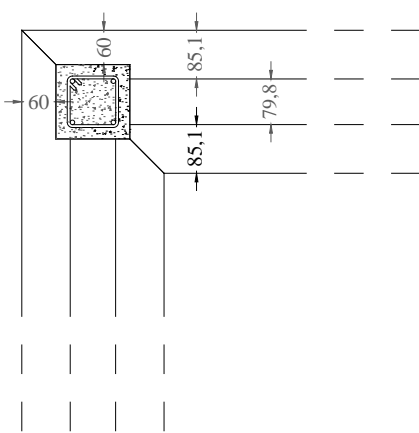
Détail des coins, 1 et 2, en plan avec le ferrailage vertical
